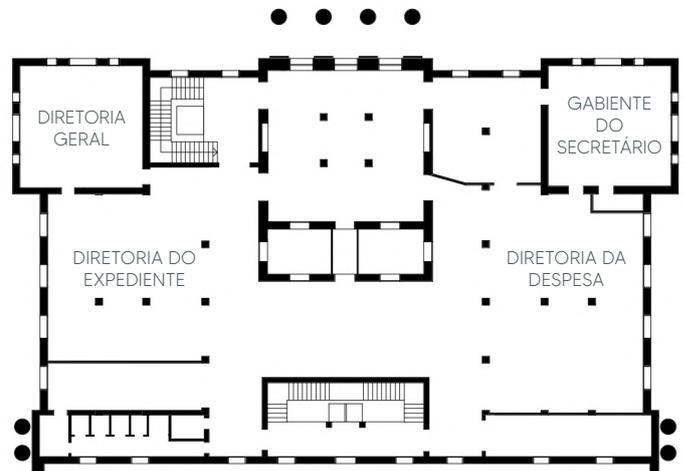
Redesenho planta do 2º andar, Secretaria da Fazenda, 1942.
